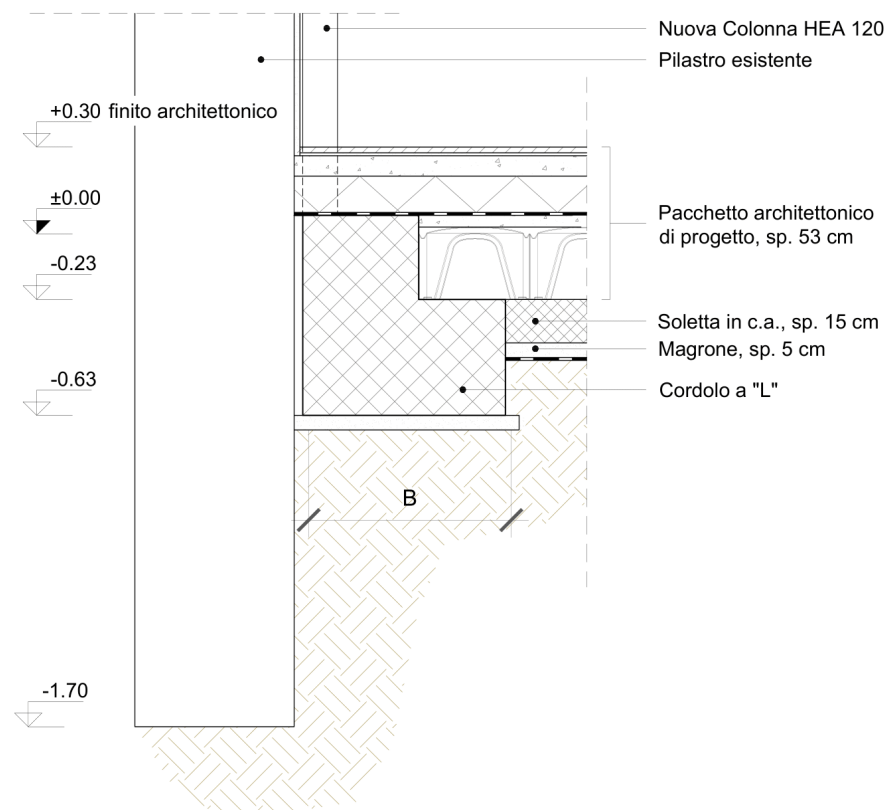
Dettaglio trave di fondazione (sezione longitudinale).
